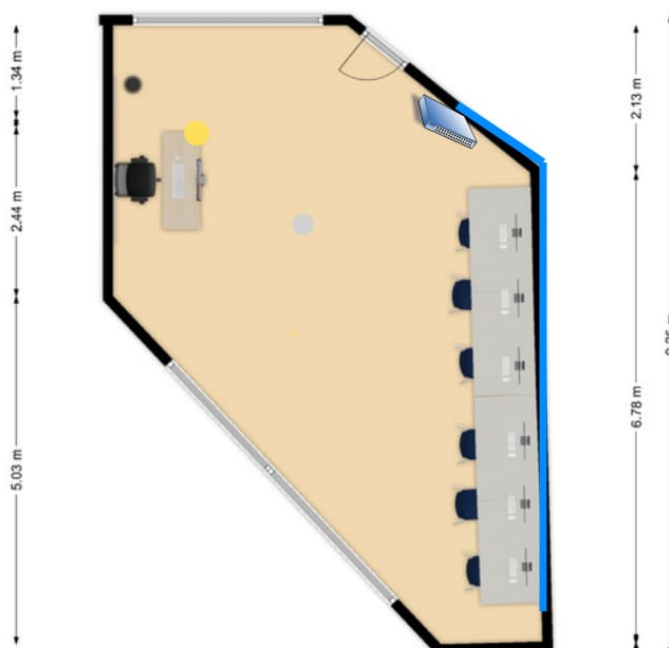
Planta 2D laboratório de manutenção com a estruturação da rede
